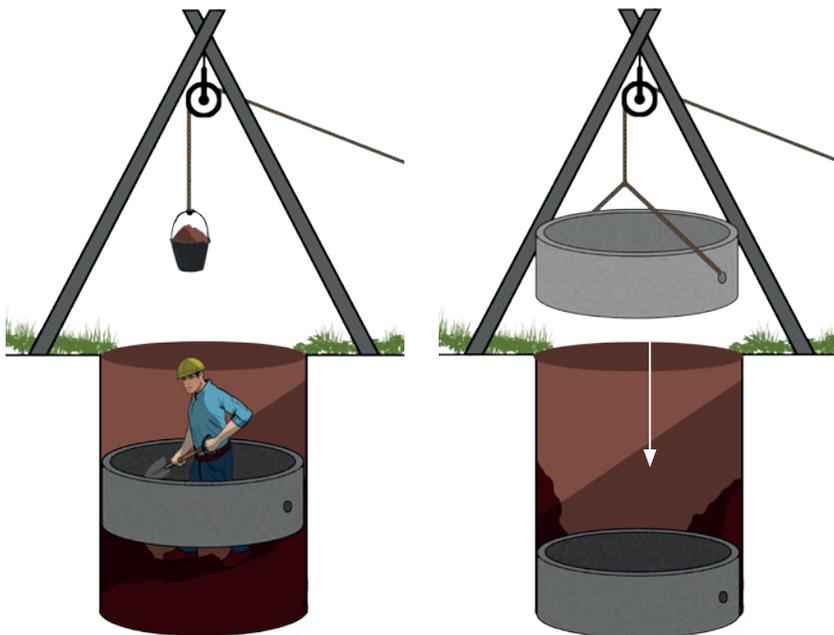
Detalle de la construcción del pozo de absorción con anillas de concreto.
